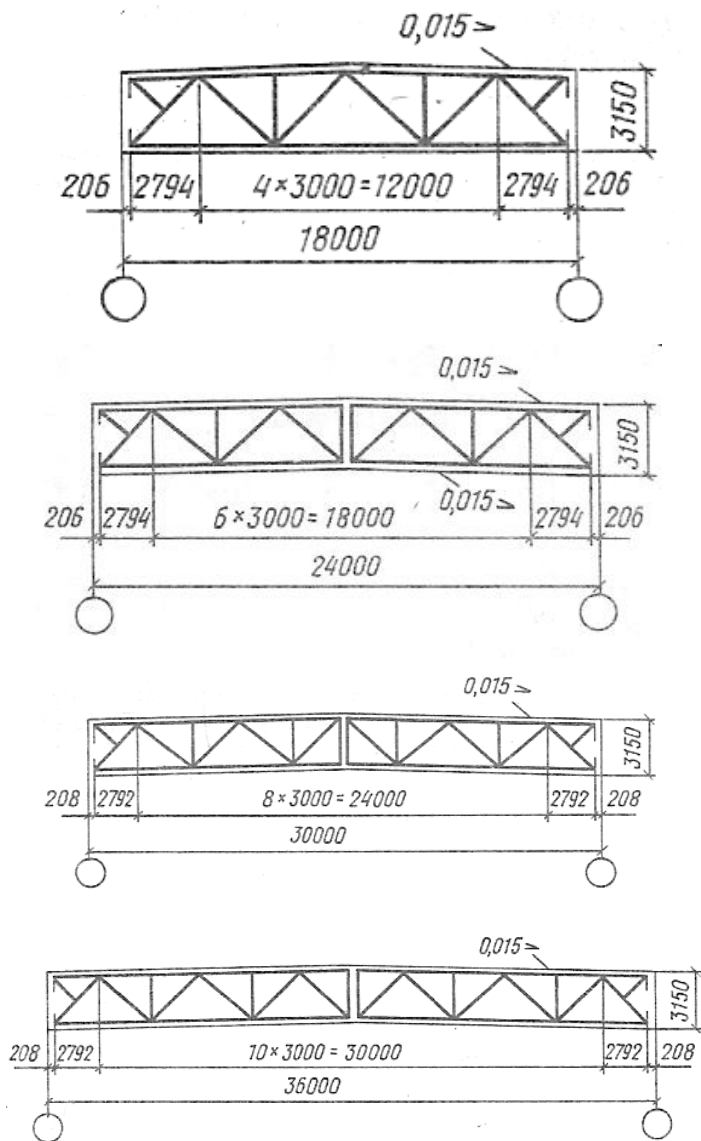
Схемы стропильных ферм нормальной высоты из прокатных уголков (с указанием отправочных элементов)
